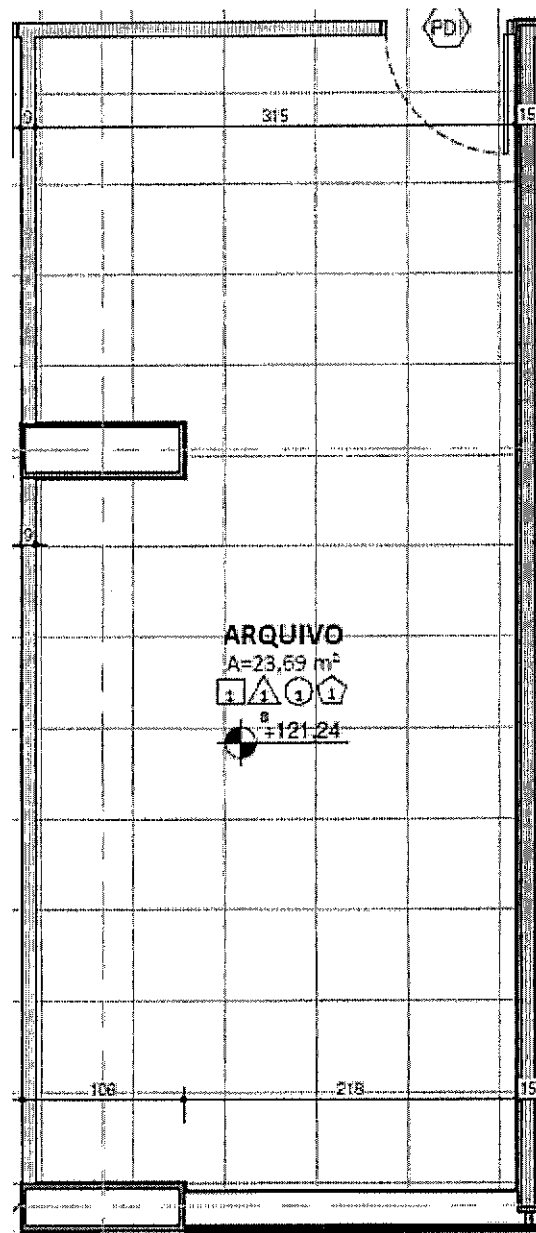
planta do 4º pavimento da obra DRF Bauru (CAT 2620180009585), área de arquivo com 23,69m². Obra de Construção.
